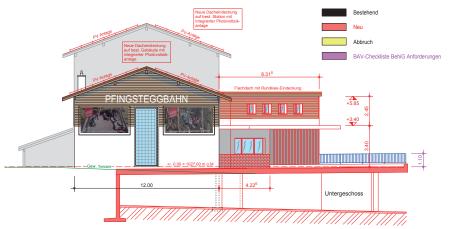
Ansicht der geplanten Nord-West-Fassade (Quelle: Bauspektrum)
